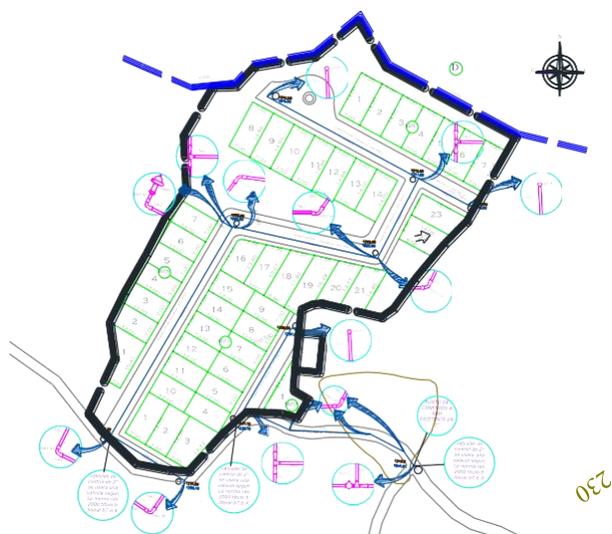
Planta de distribuciones de acueducto y detalle, proyecto urbanización Villa Isabella (Fuente empresa CENTANARO INGENIERIA S.A.S.)
